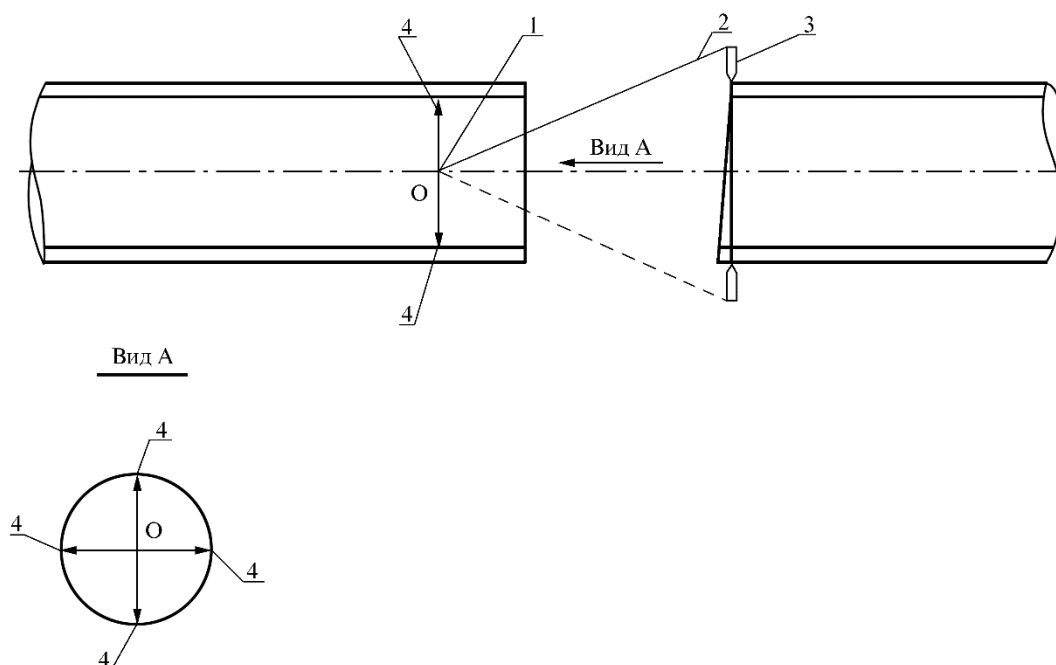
Разметка линии реза торцов трубопровода с применением приспособления
